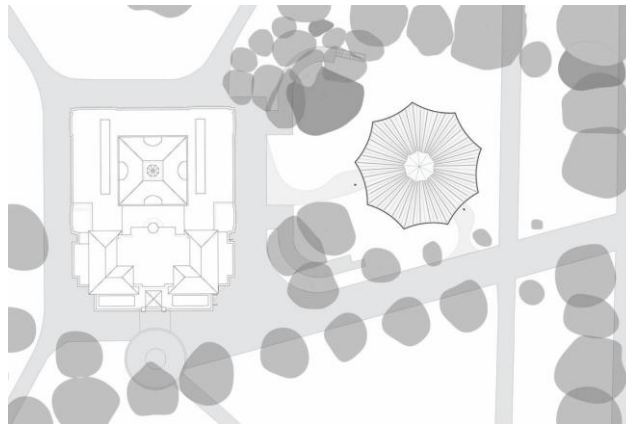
Planta de emplazamiento, Fuente: (Lina Ghotmeh — Architecture | Serpentine Pavilion, 2020)
